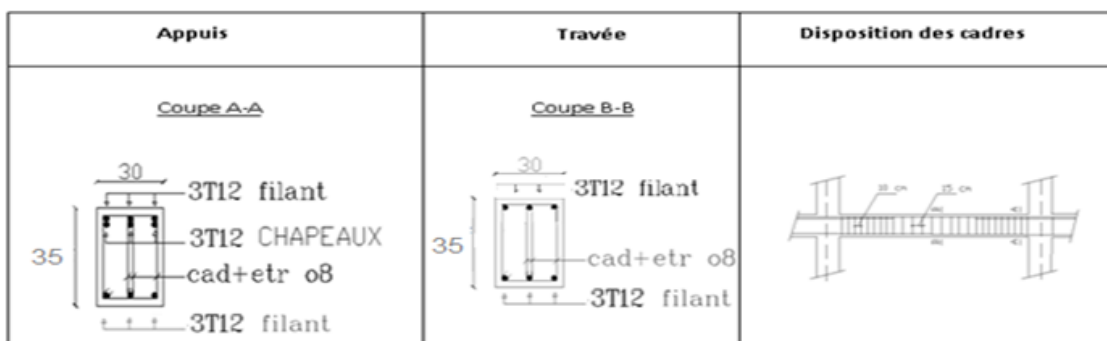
Coupe transversale de ferrailage des poutres secondaires
